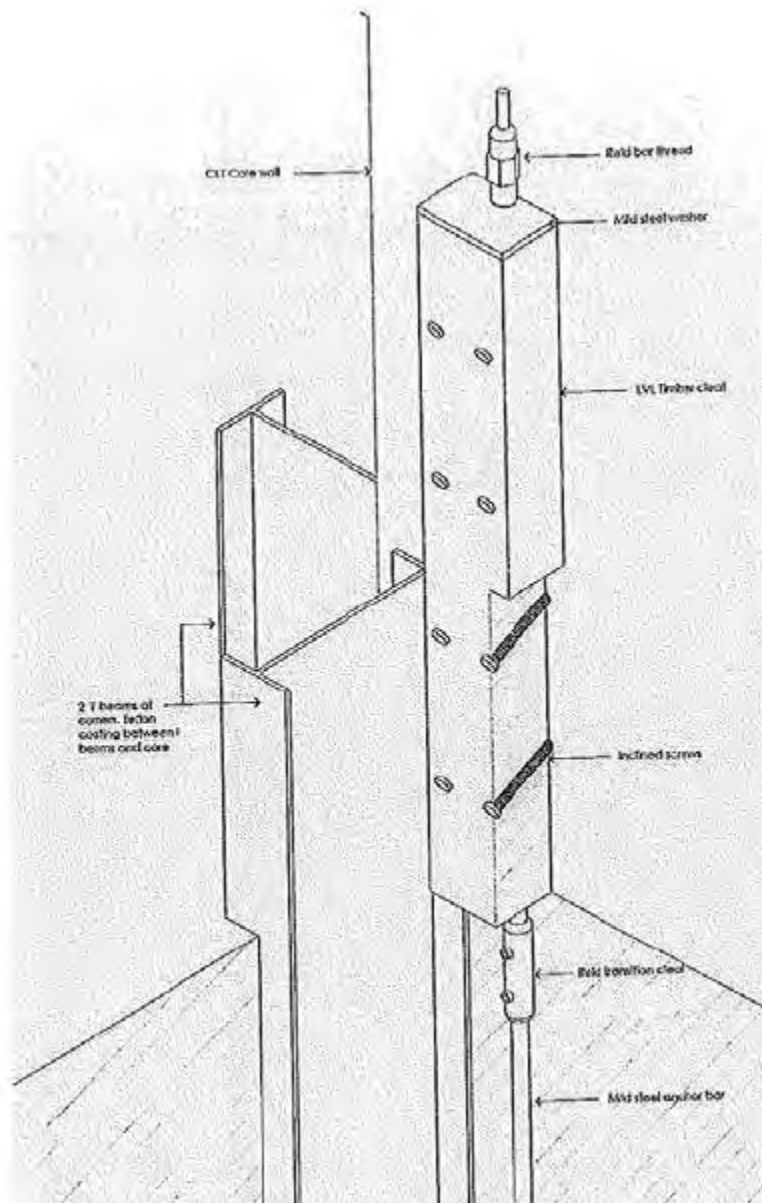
Immagine tratta da "Integrating cross-laminated timber panels to construct buildings to twenty levels" John Chapman.
